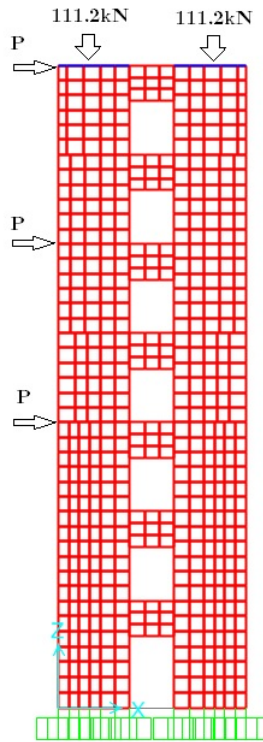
Mallado y Estado de carga de especímenes Wall A y Wall B (fuente propia)
